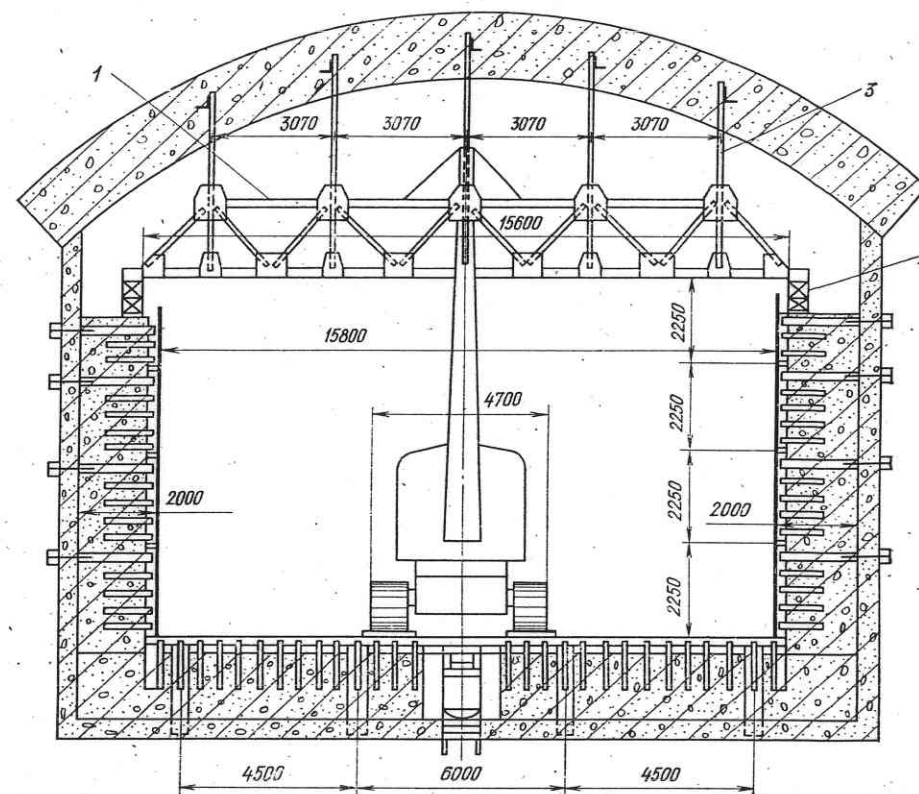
Монтаж ферм и облицовок потолка строительного туннеля гусеничным краном:
